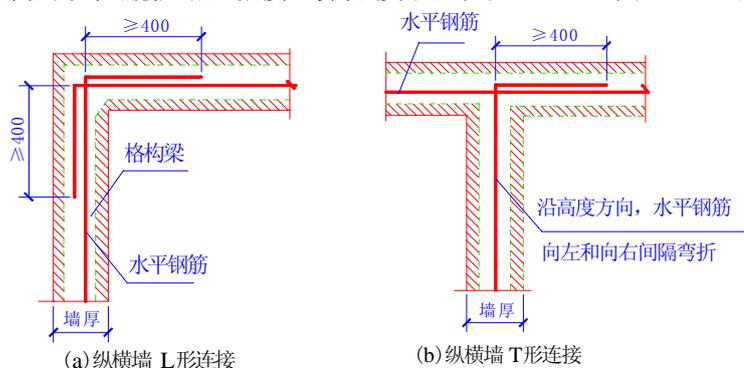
房屋墙体连接处芯孔内水平钢筋的连接
